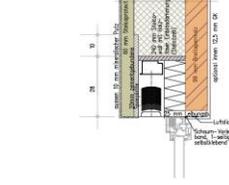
FIRST DACHAUFBAU M. 1/10
